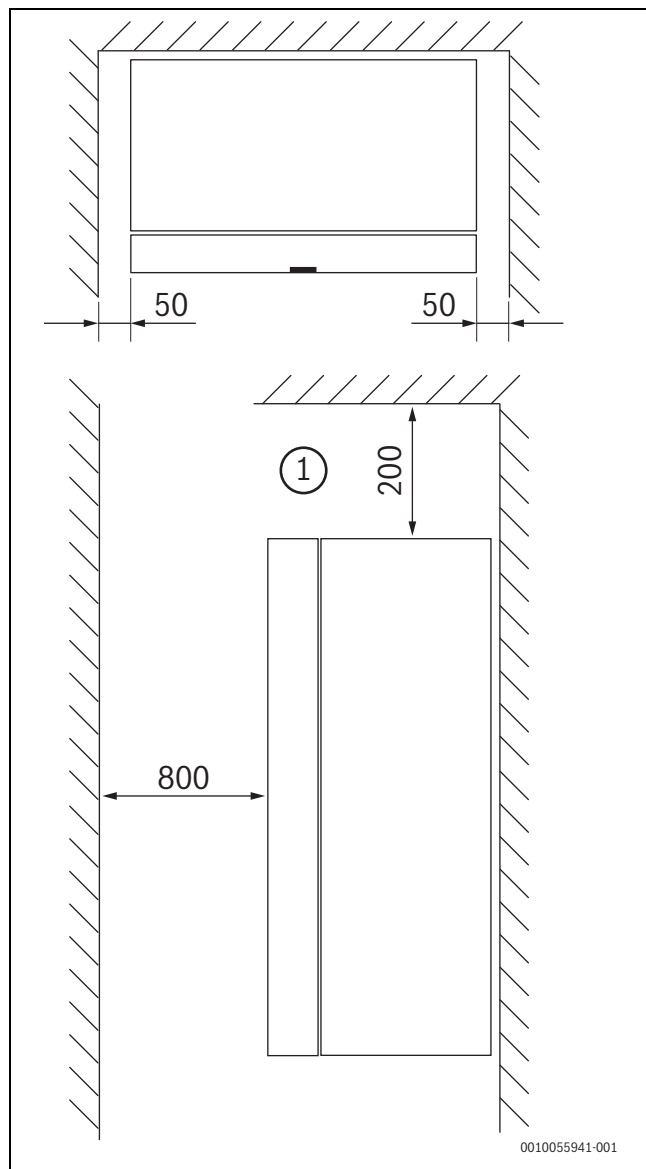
Dégradements minimaux avec les pièces ou murs voisins (mm)
